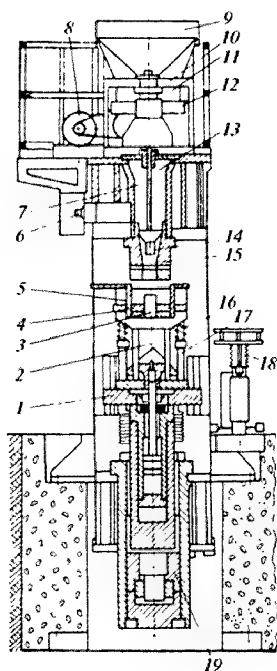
Формовочный однопозиционный агрегат с объемным дозированием и пневматической укладкой:
